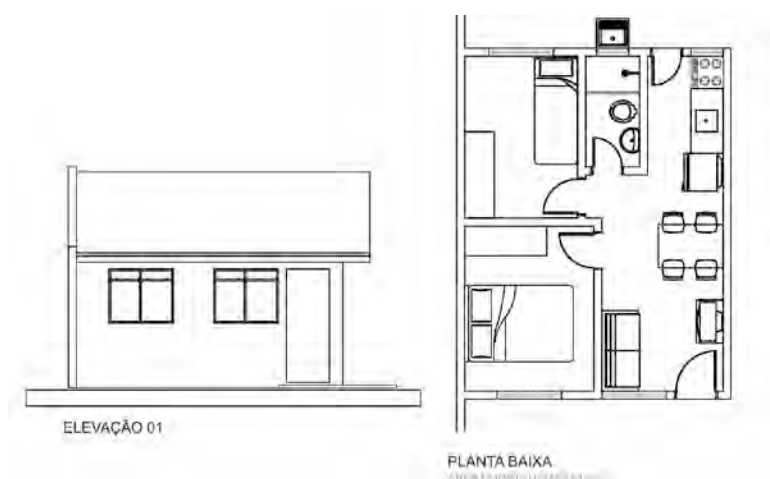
Elevação e Planta CT34A (COHAB-CT, 2006)
